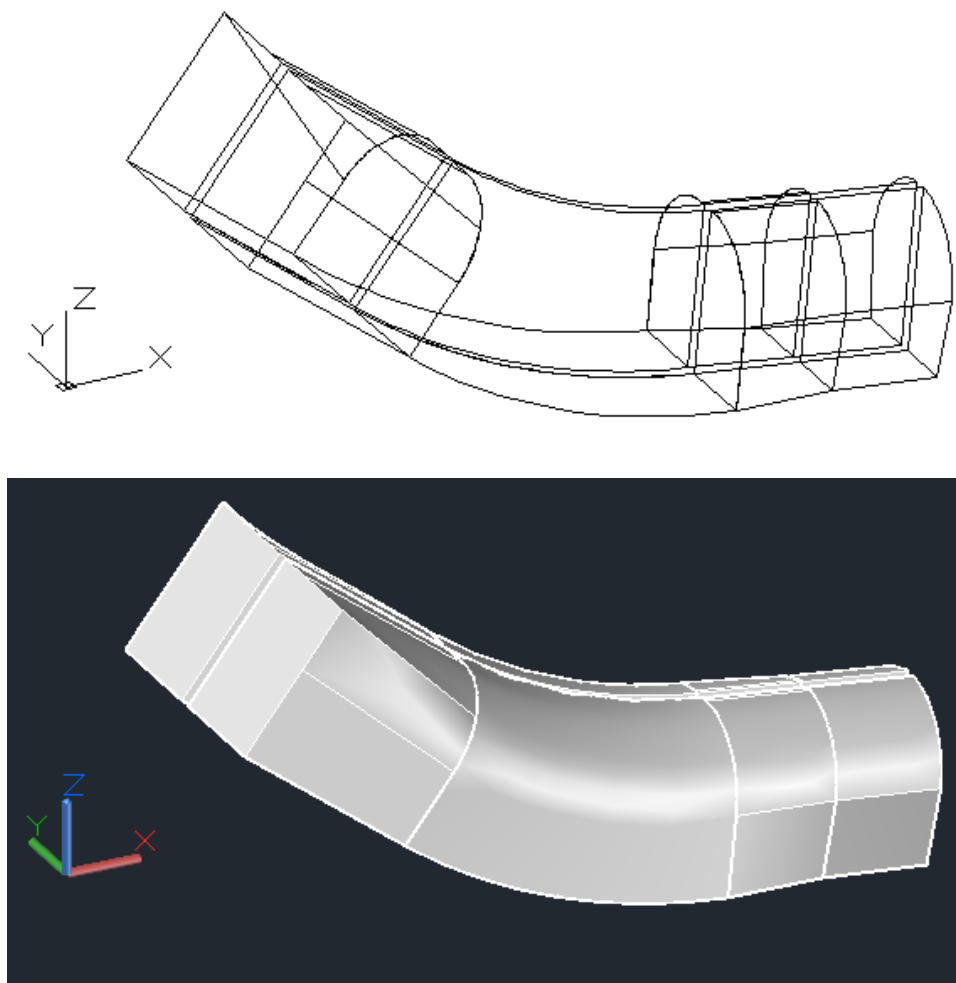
Secção interior do 2º troço do descarregador (sem e com preenchimento sólido)
